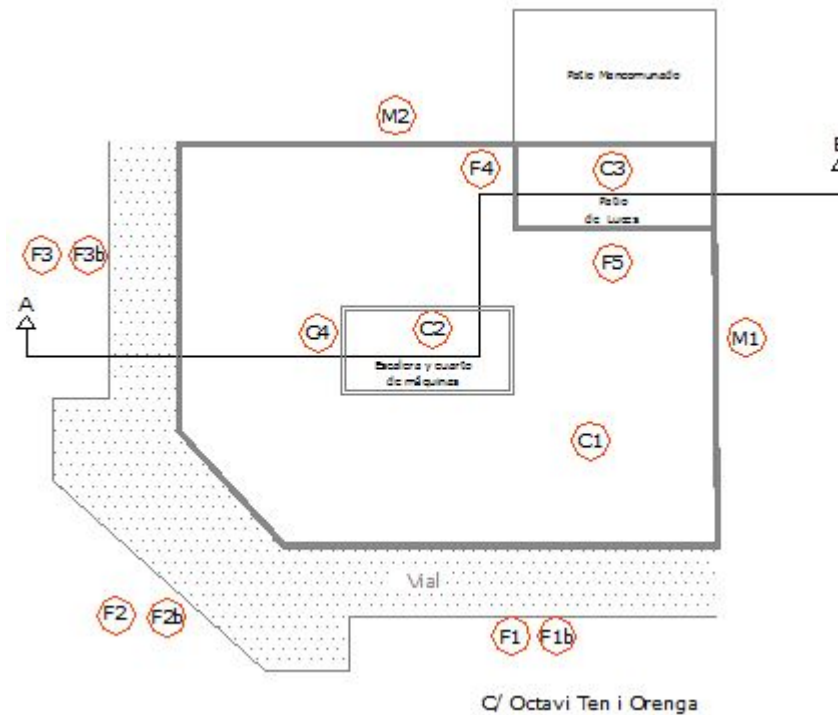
Designación en planta de los elementos constructivos [Anexo II. Planos]
